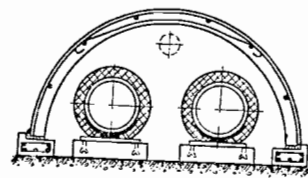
Теплопровод в железобетонном непроходном канале из скорлуп.
